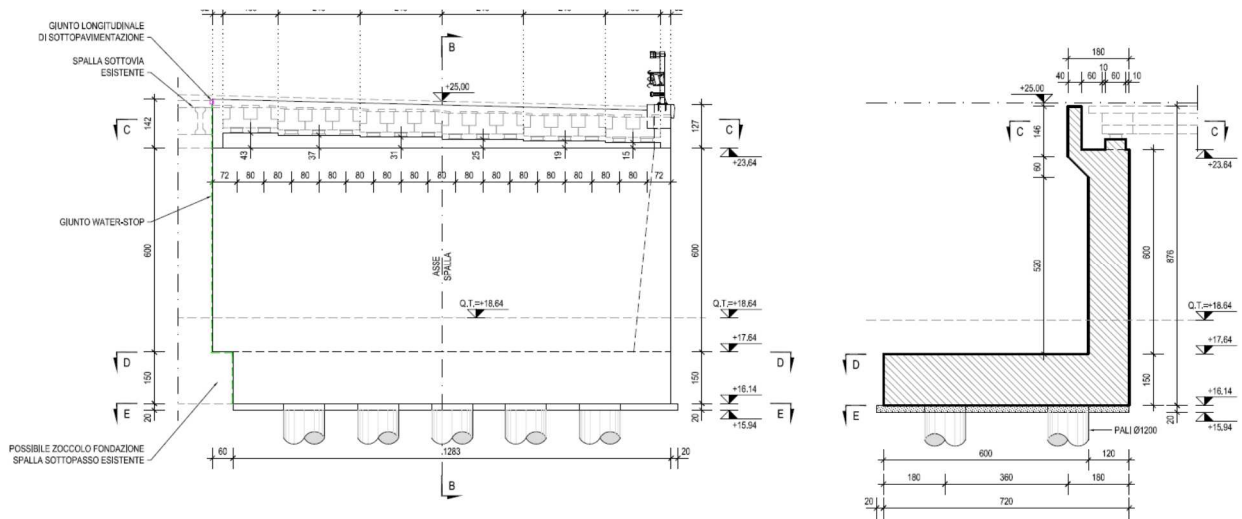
Sezione di carpenteria_Spalla 2
